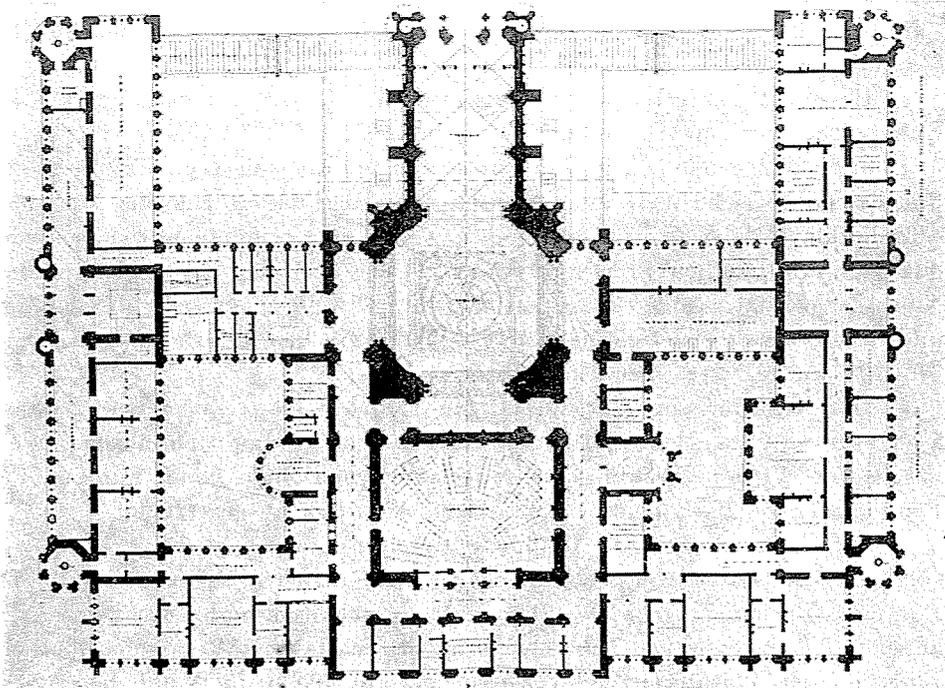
Entwurf Gilbert Scotts, 1872. Grundriß des Hauptgeschosses
